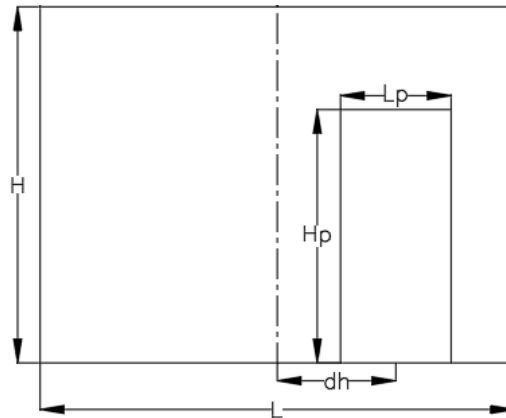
Descentramiento horizontal abertura tipo puerta
